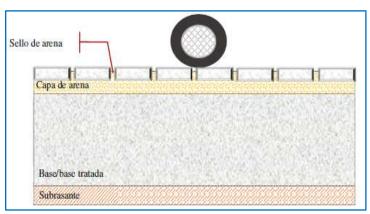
Estructura y distribución de cargas en pavimento semirrígido o adoquinado
